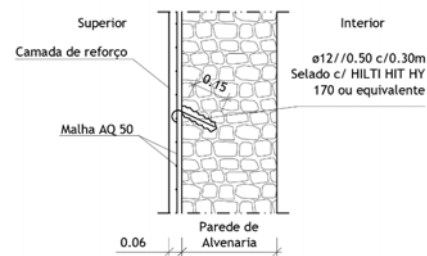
Pormenor de reforço das paredes de alvenaria fonte: Projeto de Execução
